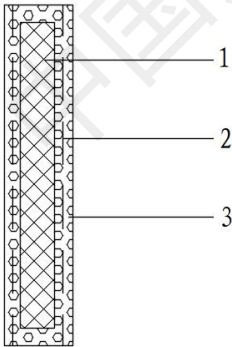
单层真空绝热复合保温板构造示意图
